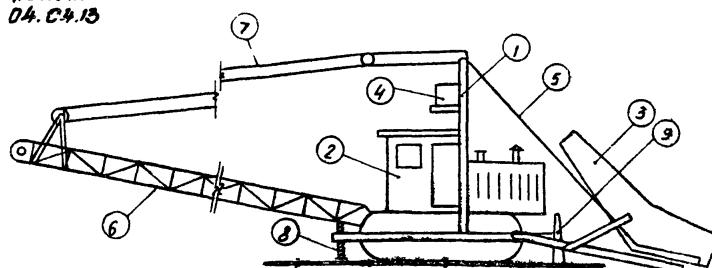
Схема самоходного бетоноукладчика на базе бульдозера Д-159
